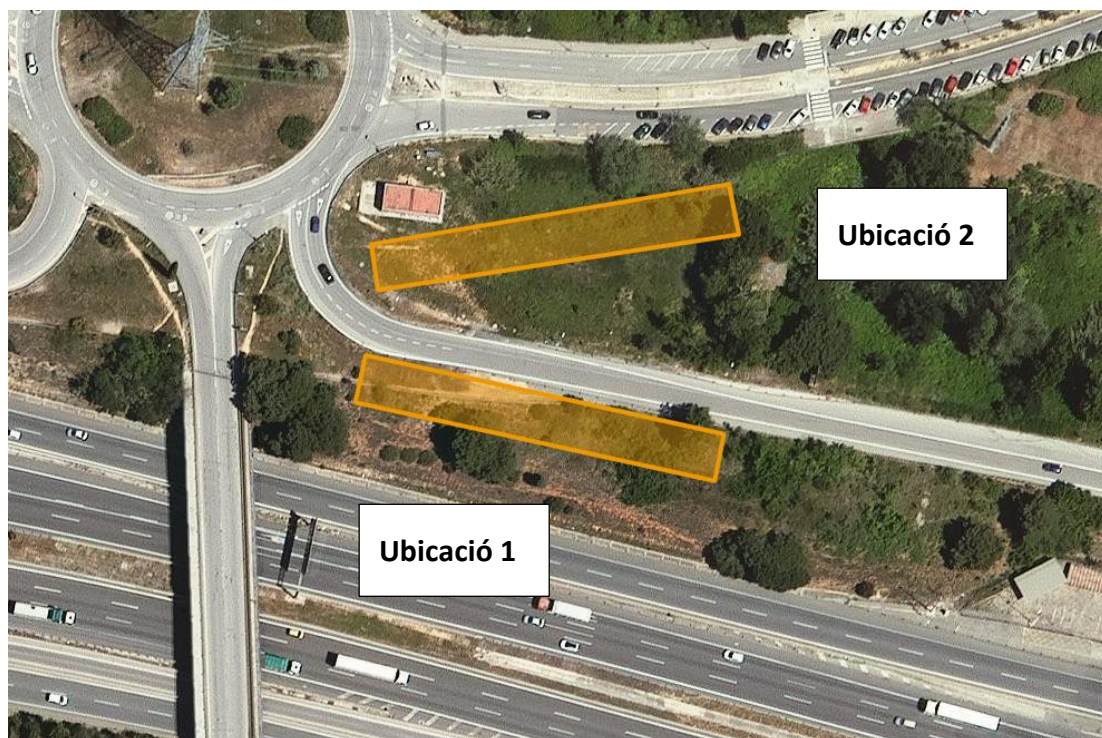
Planta Estructura ( 80 x 10) en zona de Muntatge Nord.
